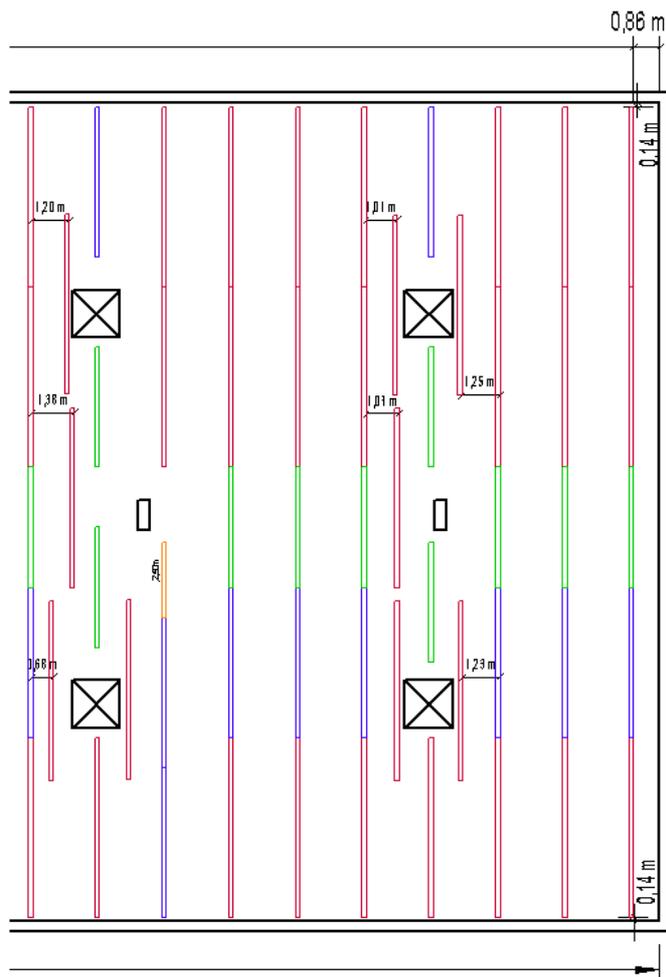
Montageplan Grundschiene (Planausschnitt als Beispiel)
